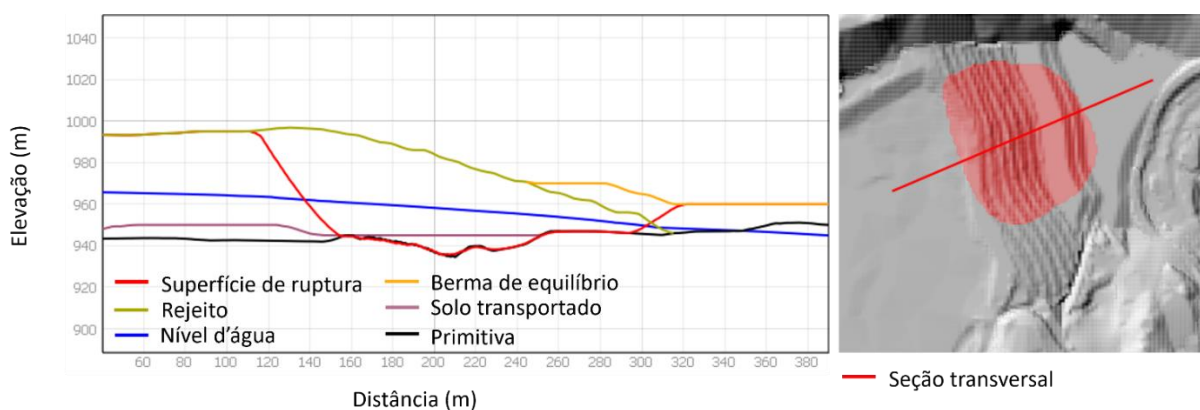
Cunha crítica para a geometria final da pilha – Planta e seção transversal
